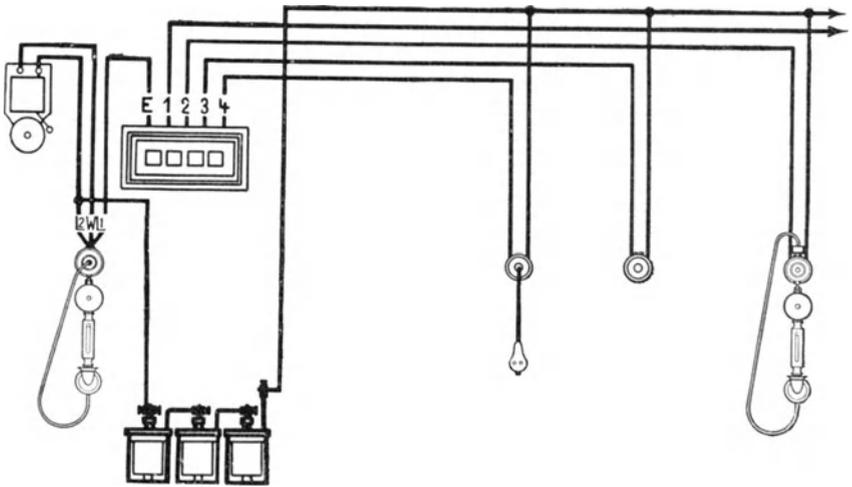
Haustelephonanlage mit Verwendung der Leitungen einer Tableauanlage.
